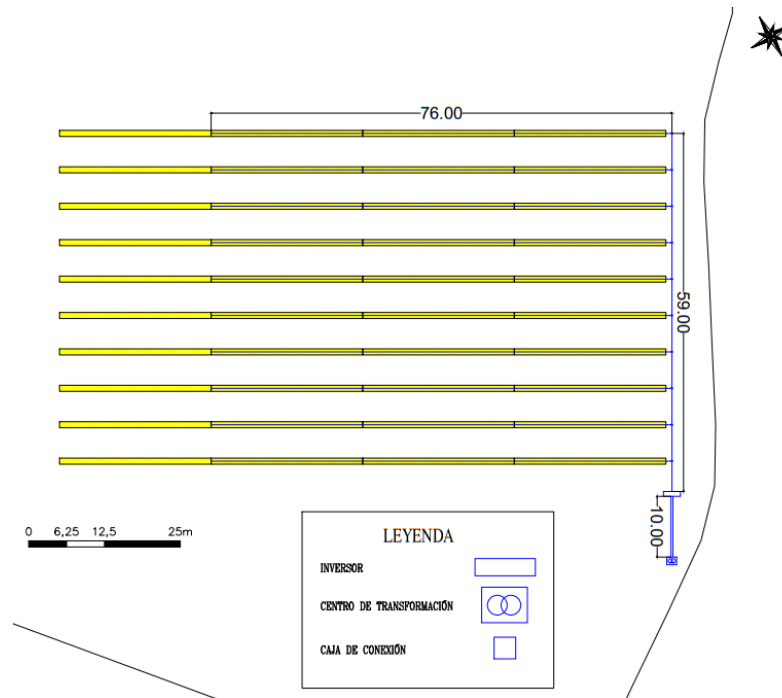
Instalación eléctrica del sistema agrivoltaico elevado.
